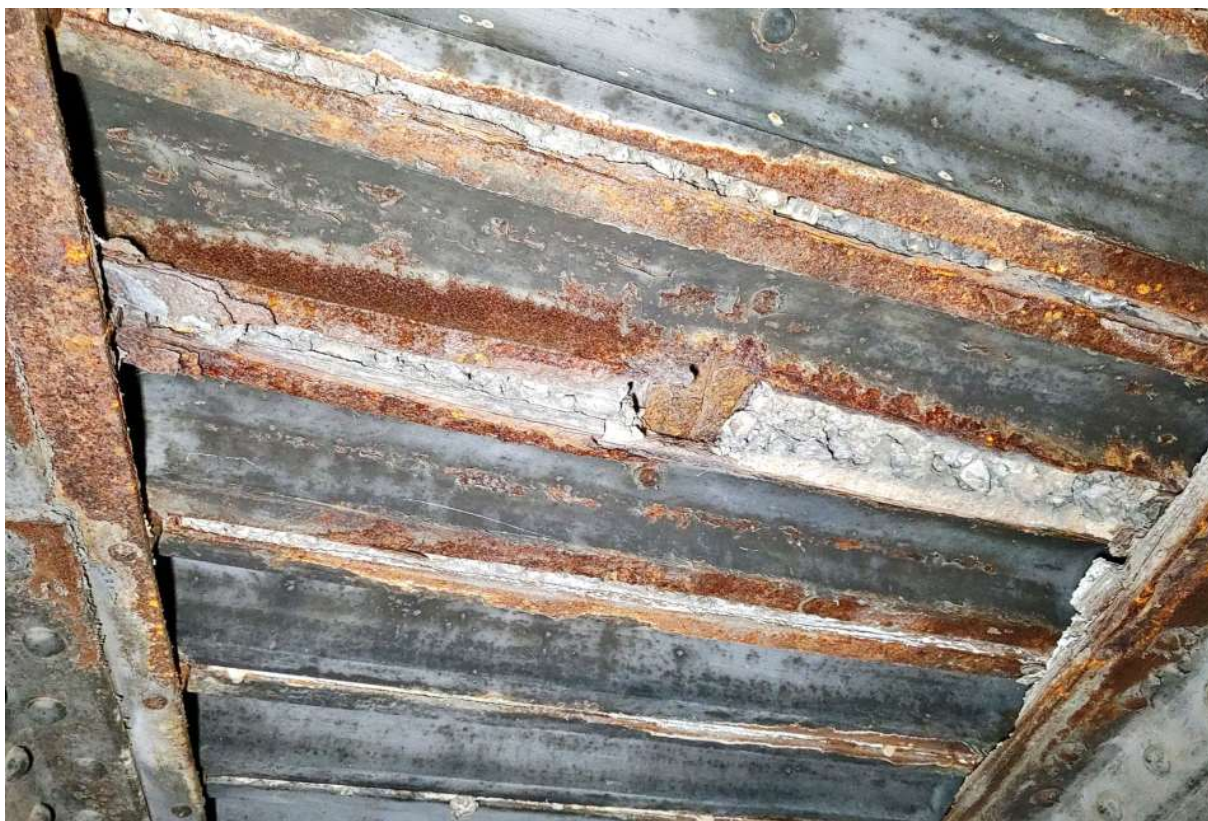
P2 - krycí silniční plech nad konstrukcí K01 - 60x15 cm - lokálně do ostra
